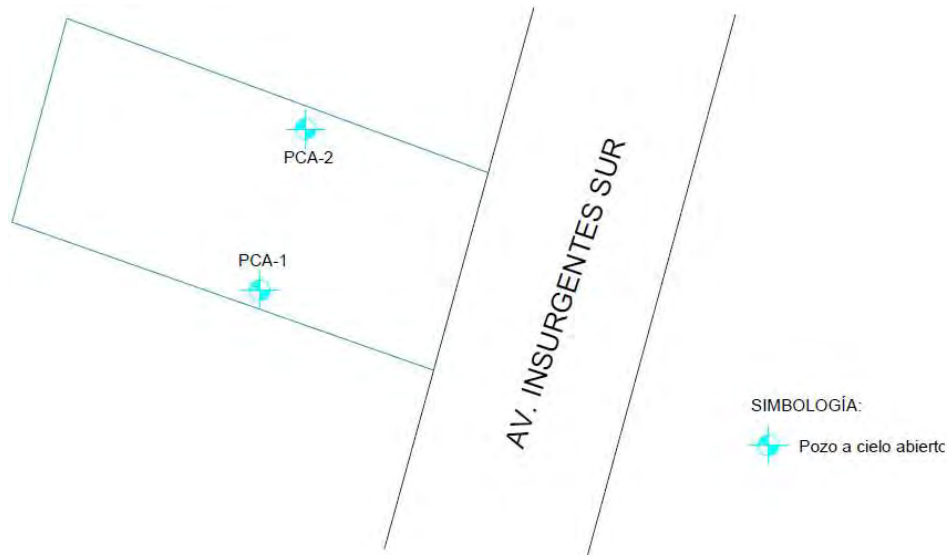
PLANTA DEL TERRENO CON LA UBICACIÓN DE LOS SONDEOS PCA
